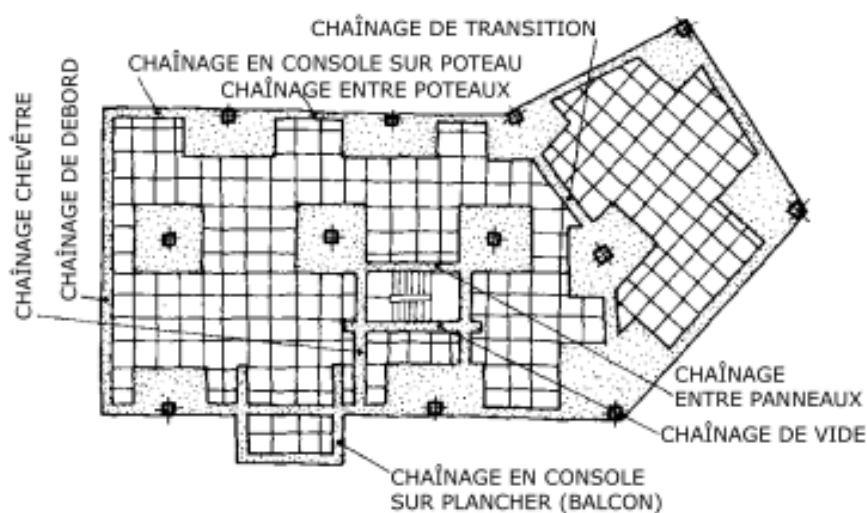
ELEMENTS D'UNE STRUCTURE EN DALLE RETICULEE
